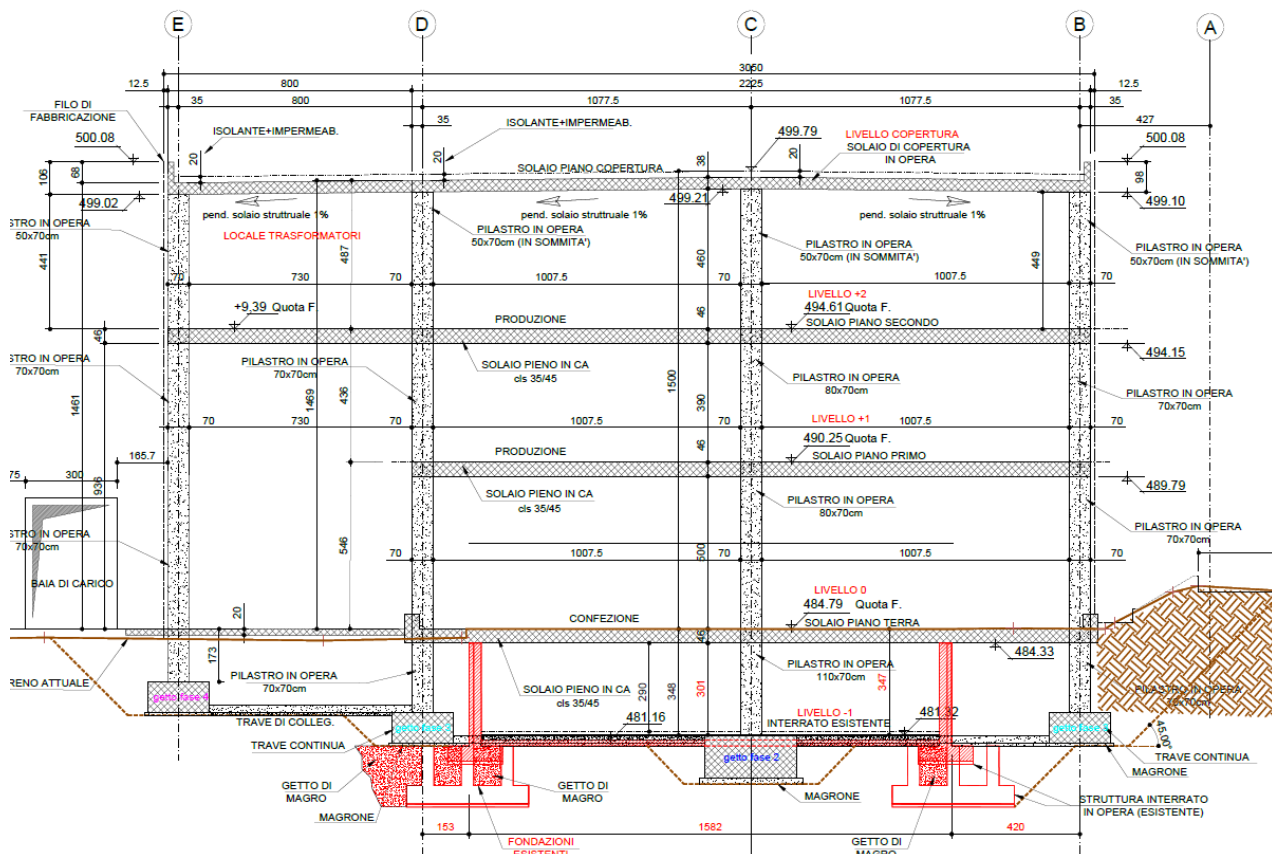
Sezione trasversale B-B – Fabbricato Ex. Piemonte
